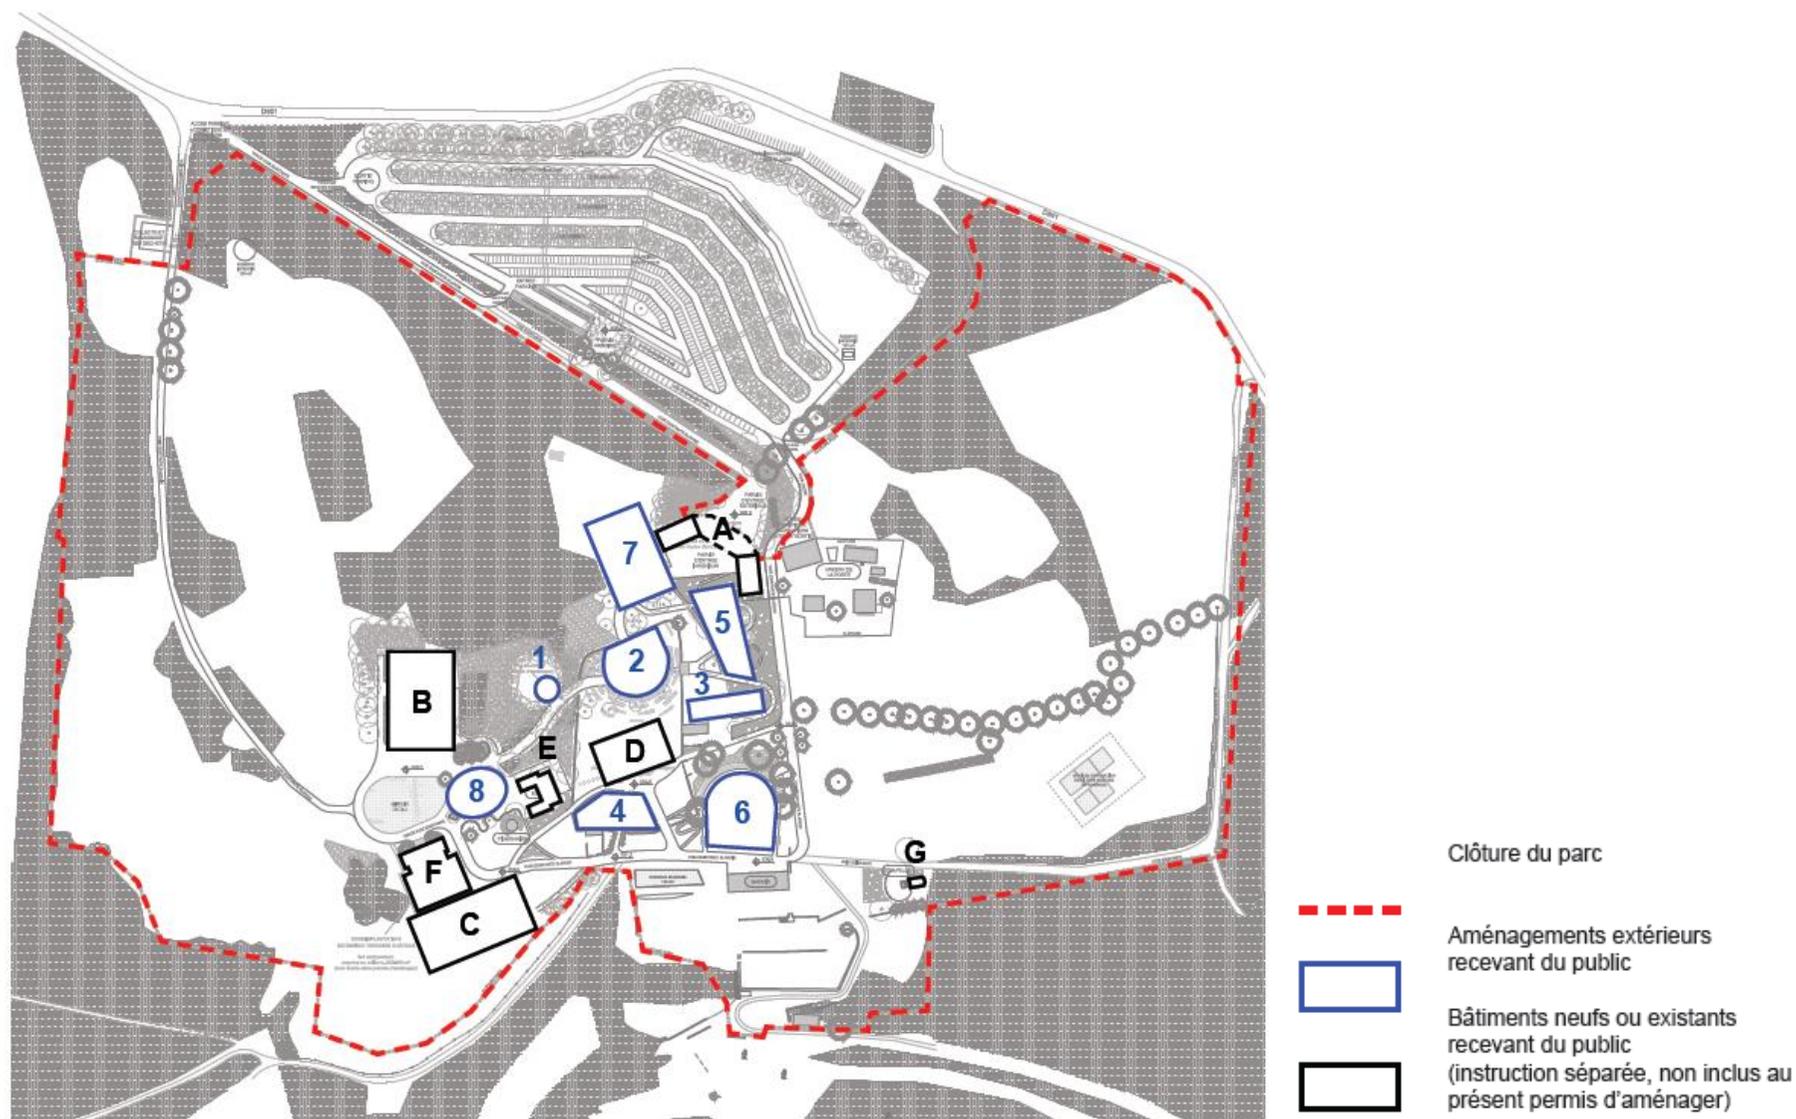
Plan de localisation des installations ERP (Source : Notice explicative – COCO Architecture, Décembre 2022)
